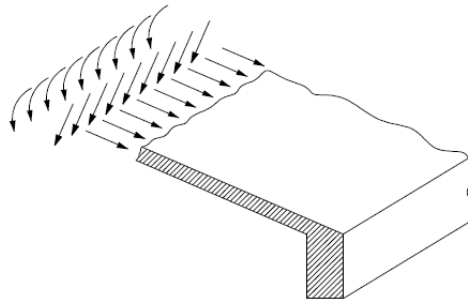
Viga de apoio de uma laje inclinada [3]
